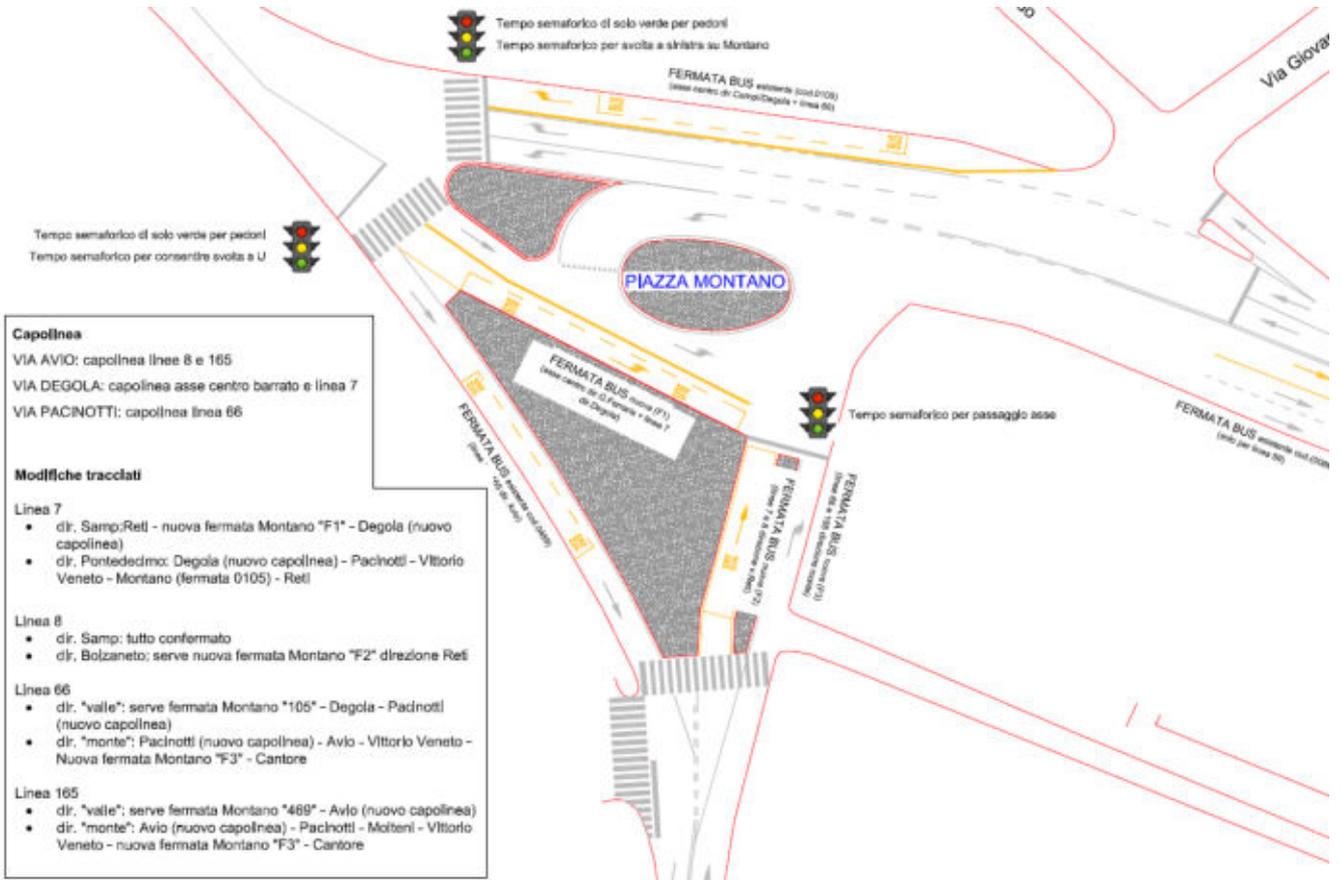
schema layout H2 Piazza Montano – Cantore – (soluzione e fonte SA)
